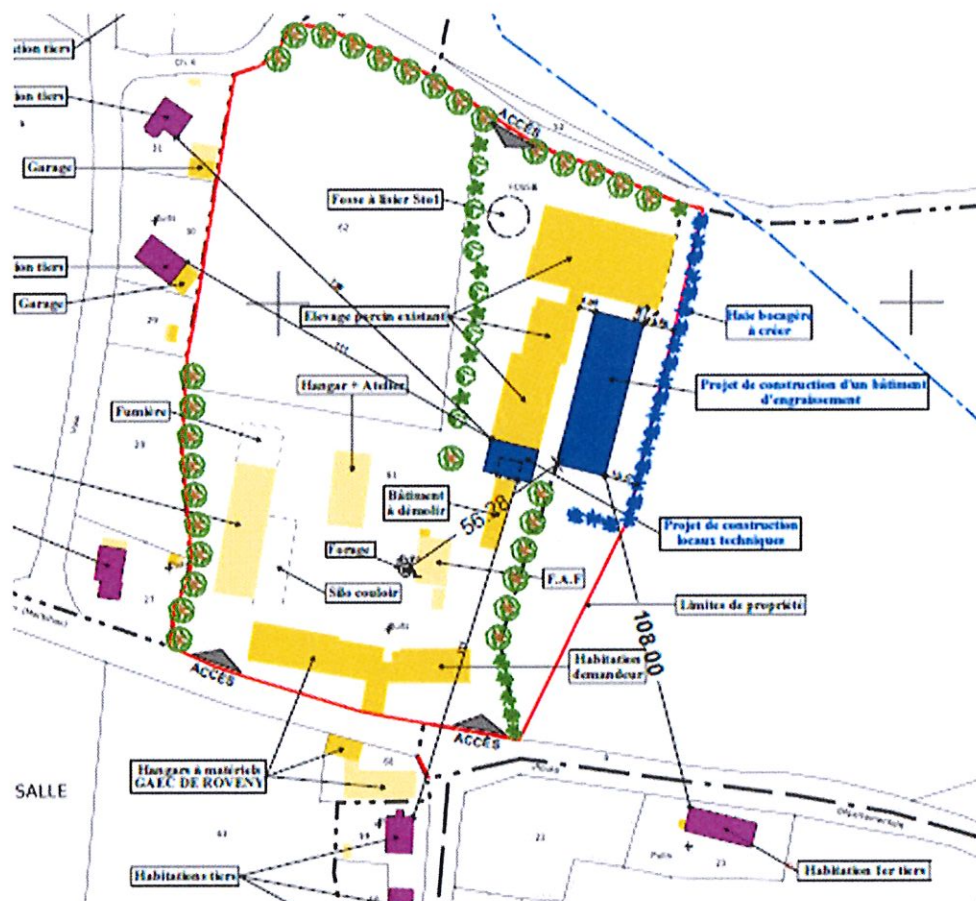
plan de situation à échelle réduite - site de la salle LA CHAPELLE THOUARAUULT
